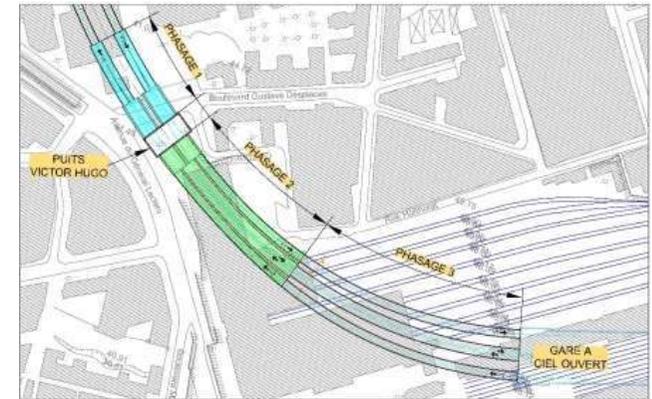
Vue en plan de l'entonnement nord (EGIS, 2021)
